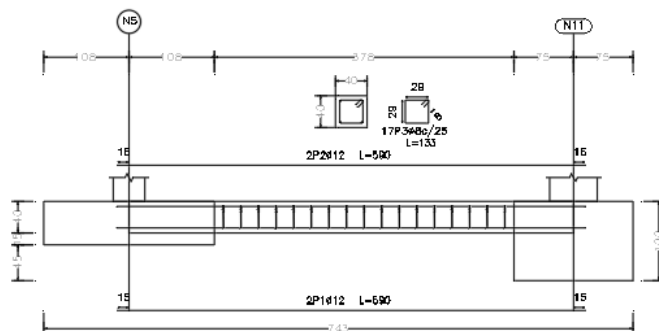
Viga de atado entre zapatas de pilares laterales de pórticos interiores.
